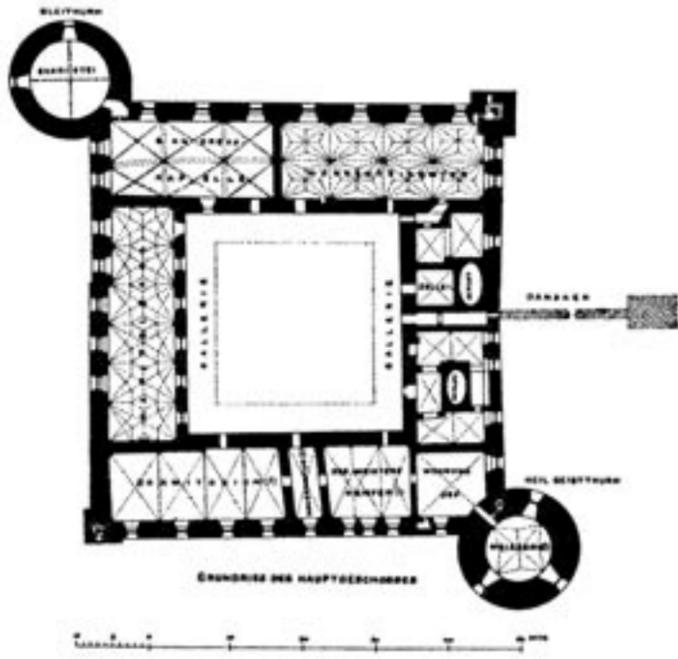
Grundriss des Hauptgeschosses der Deutschordensburg in Riga mit Rekonstruktion der Raumnutzung nach TUULSE 1942.
